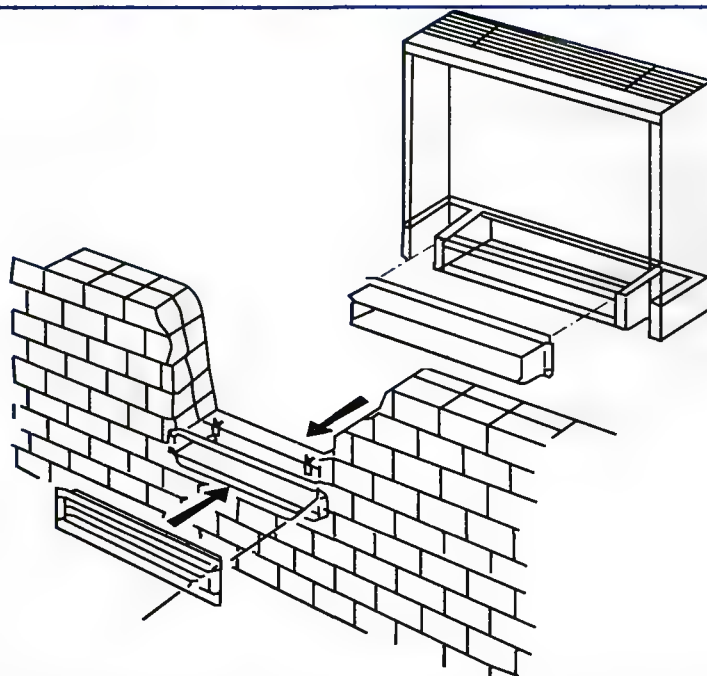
Монтаж фэнкойла с забором наружного воздуха
